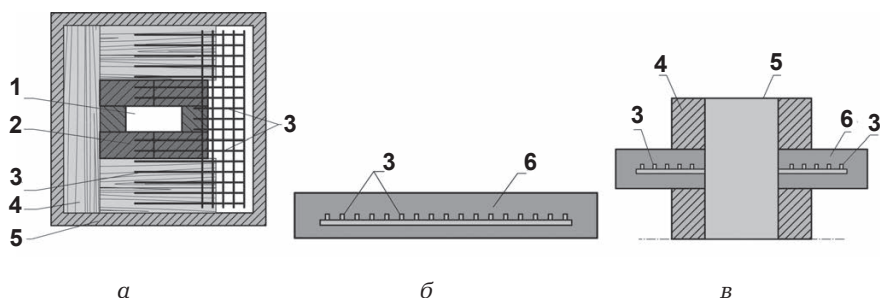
Изготовление железобетонной выгры: а — опалубка с арматурой; б — разрез плиты; в — плита в печной кладке; 1 — дымоход; 2 — печная кладка; 3 — арматура; 4 — бортики; 5 — опалубка; 6 — плита
